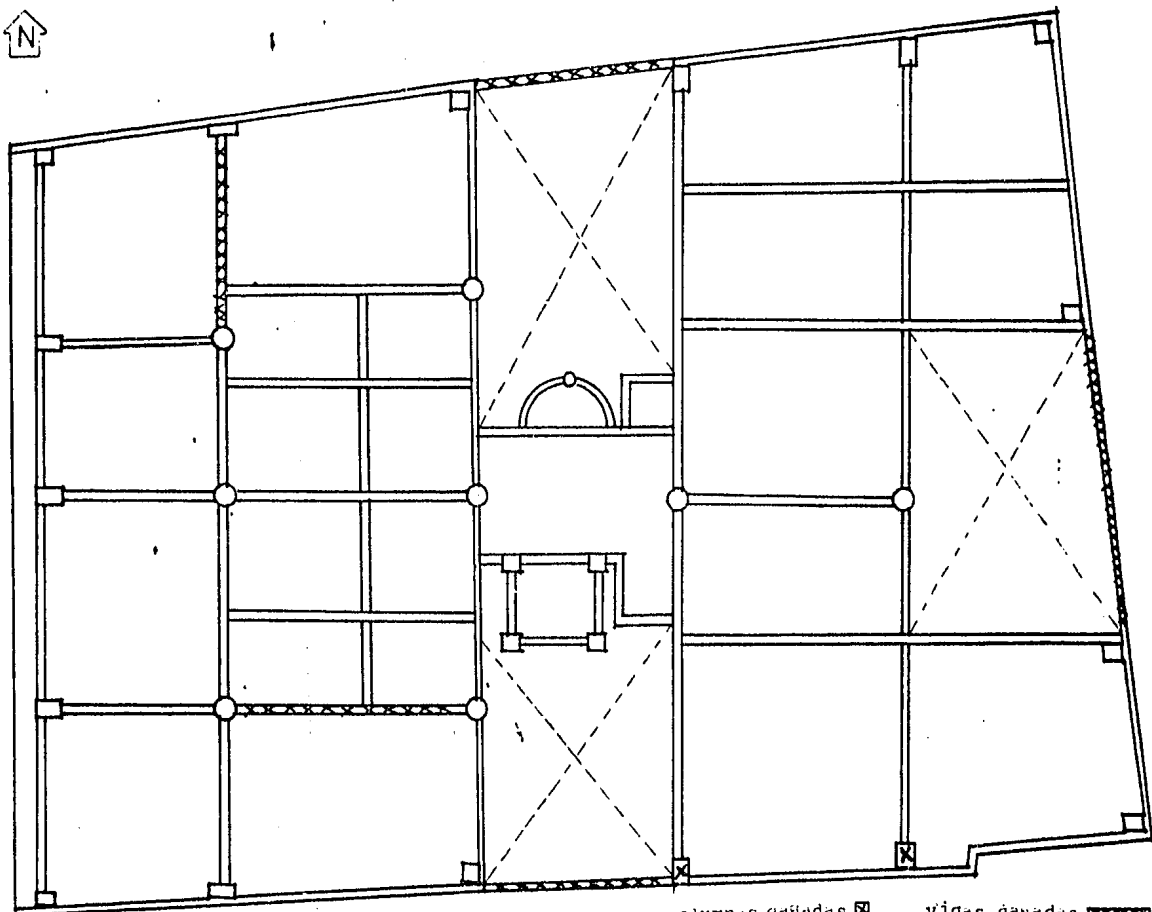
Fig.II.LC. Daños en los elementos estructurales del nivel 4
